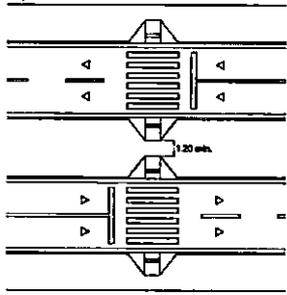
Canteiro divisor de pistas - Exemplo 1
